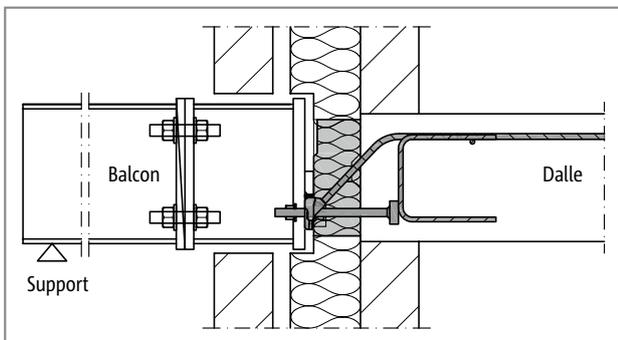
Schöck Isokorb® T type SQ : Corps isolant dans l'isolation du noyau ; la pièce de liaison sur site entre l'élément Isokorb® et le balcon permet une certaine flexibilité dans le processus de construction
